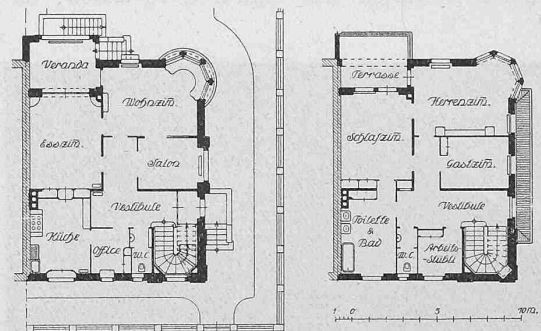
und 2. Grundrisse vom Erdgeschoss und I. Stock.
